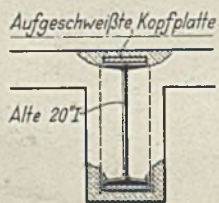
Alter 20" I-Träger mit aufgeschweißten Gurtplatten.
